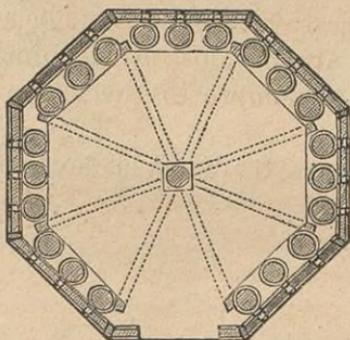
<sup>a</sup>—Planta de un colmenar cubierto.
